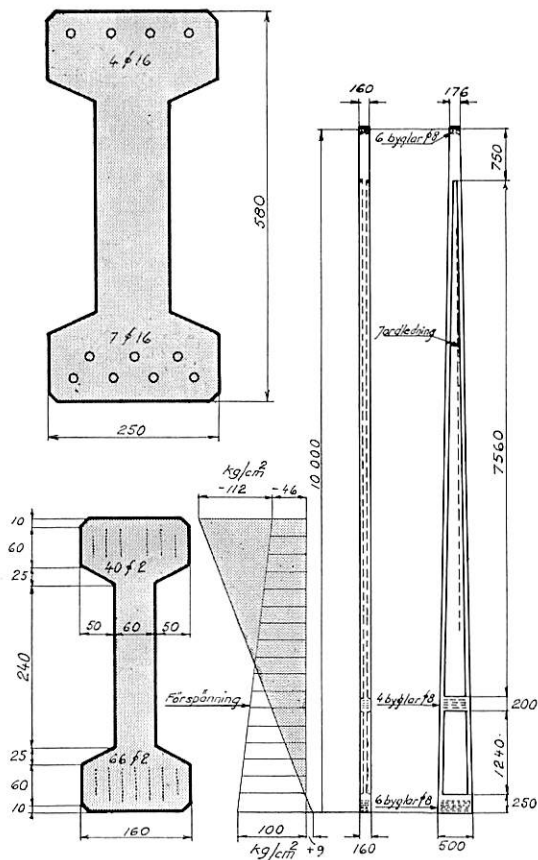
Strängbetongstolpe. Brottmoment = 15.5 ton. Överst till vänster därmed jämnstark betongstolpe med vanlig armering.
